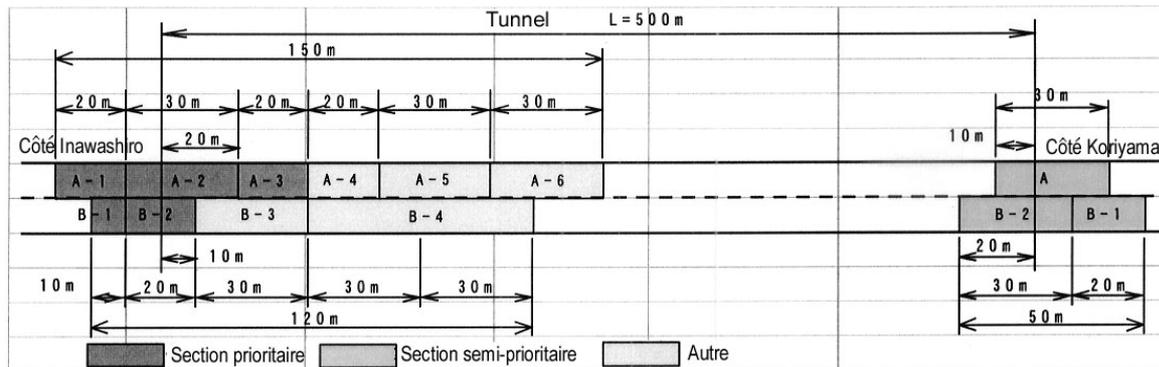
Système de régulation du chauffage de la chaussée par division de la route en sections
